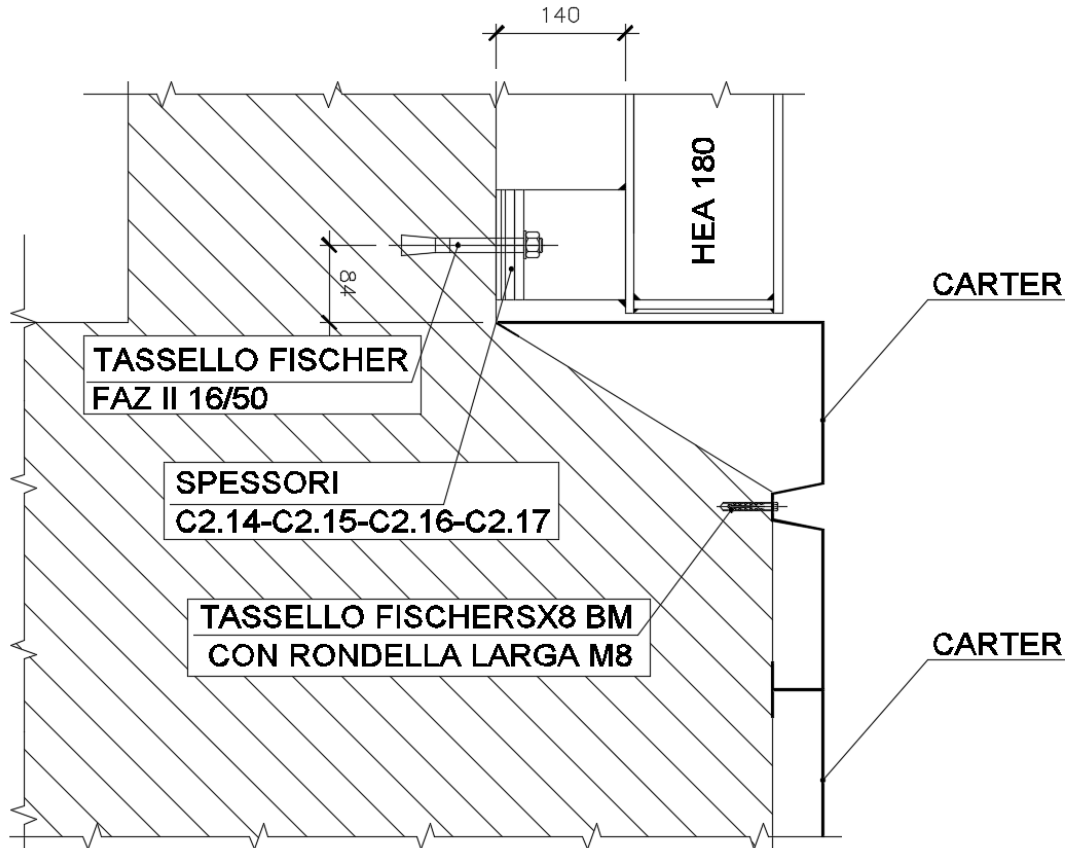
Dettaglio del collegamento inferiore HEA180 alto barriera testata galleria
